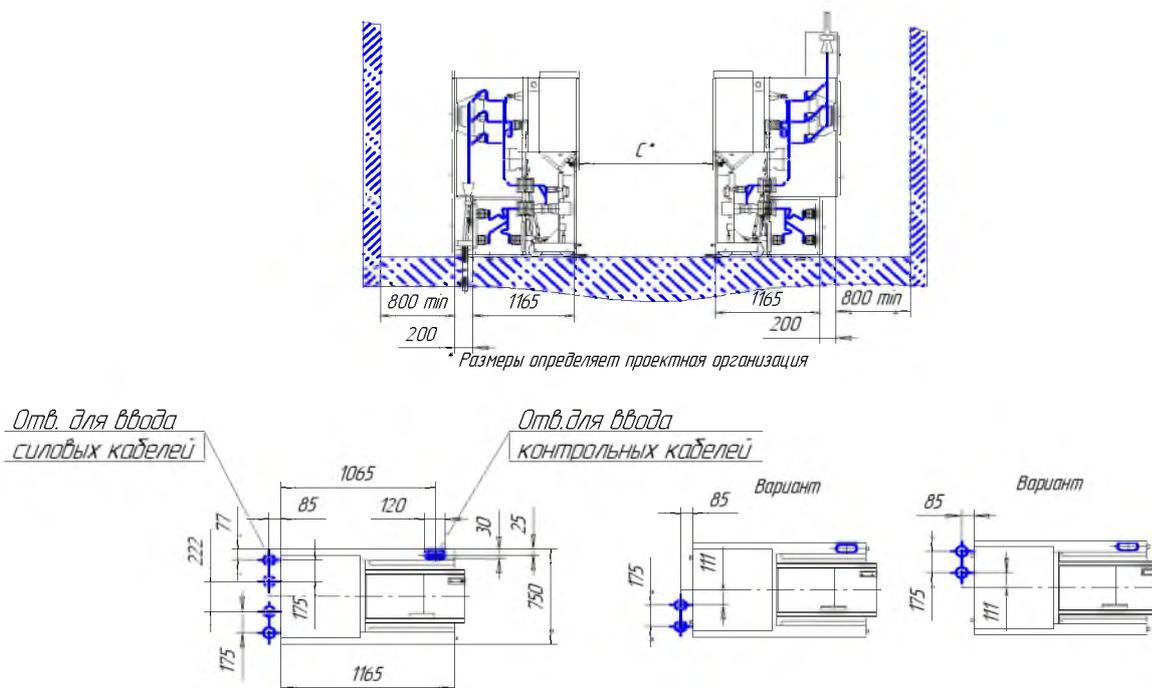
Установка шкафов с кабельным вводом снизу внутри и с кабельным вводом сверху на фундамент
